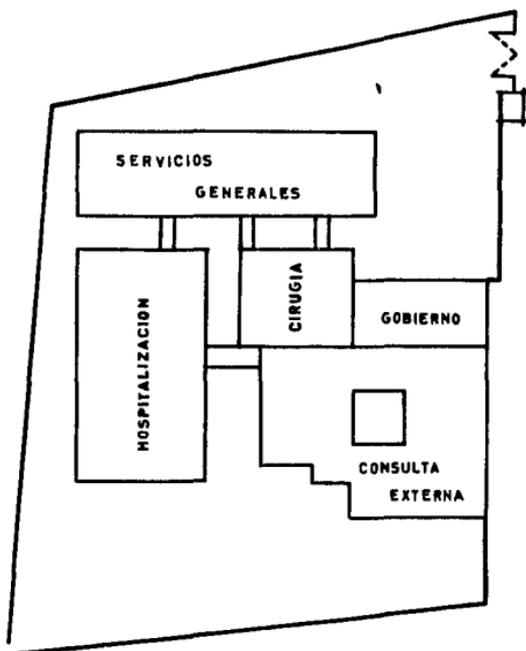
Croquis de la Planta de Conjunto del Hospital Rural de Jojutla, Mor.
